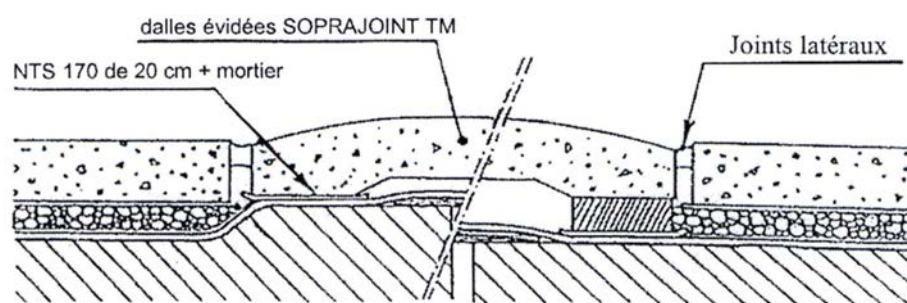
Protection des joints plats en toitures accessibles aux véhicules
